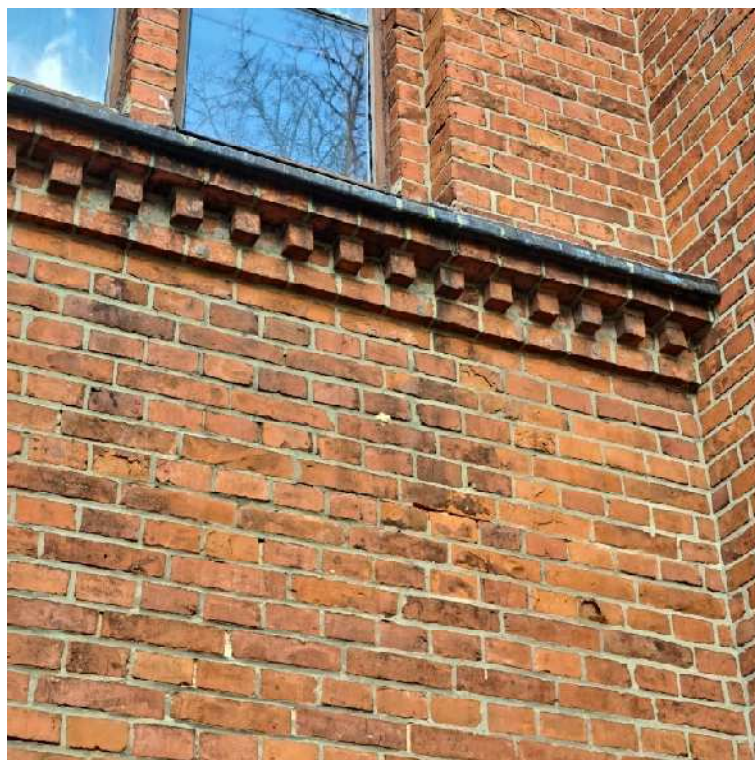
Widok na elewację północną – przewidzianą do realizacji (1)
